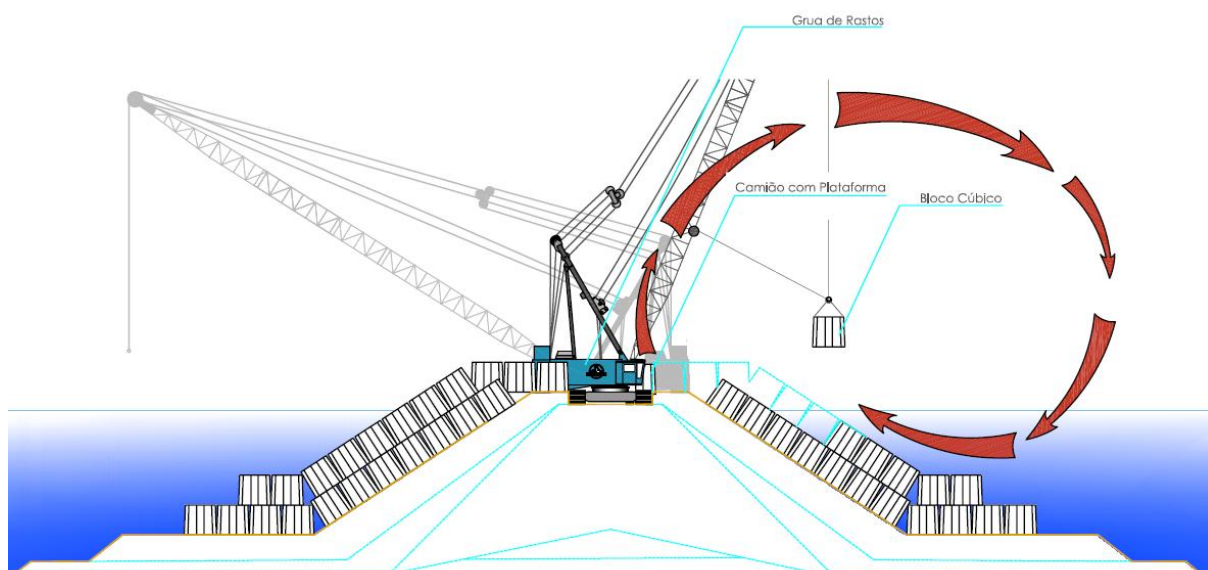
Construção do manto resistente, colocação de blocos Antifer por meios terrestres, esquema em corte longitudinal 2. (ETERMAR – Engenharia e construção S.A.)
